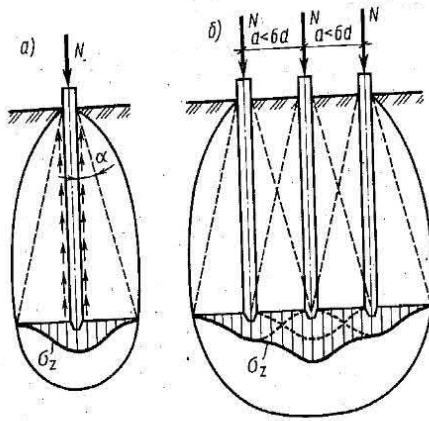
Схемы передачи нагрузки на грунт основания:
